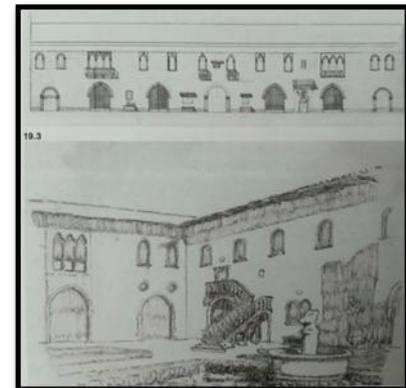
Fachada e perspectiva do projeto do Pavilhão Napoleônico
